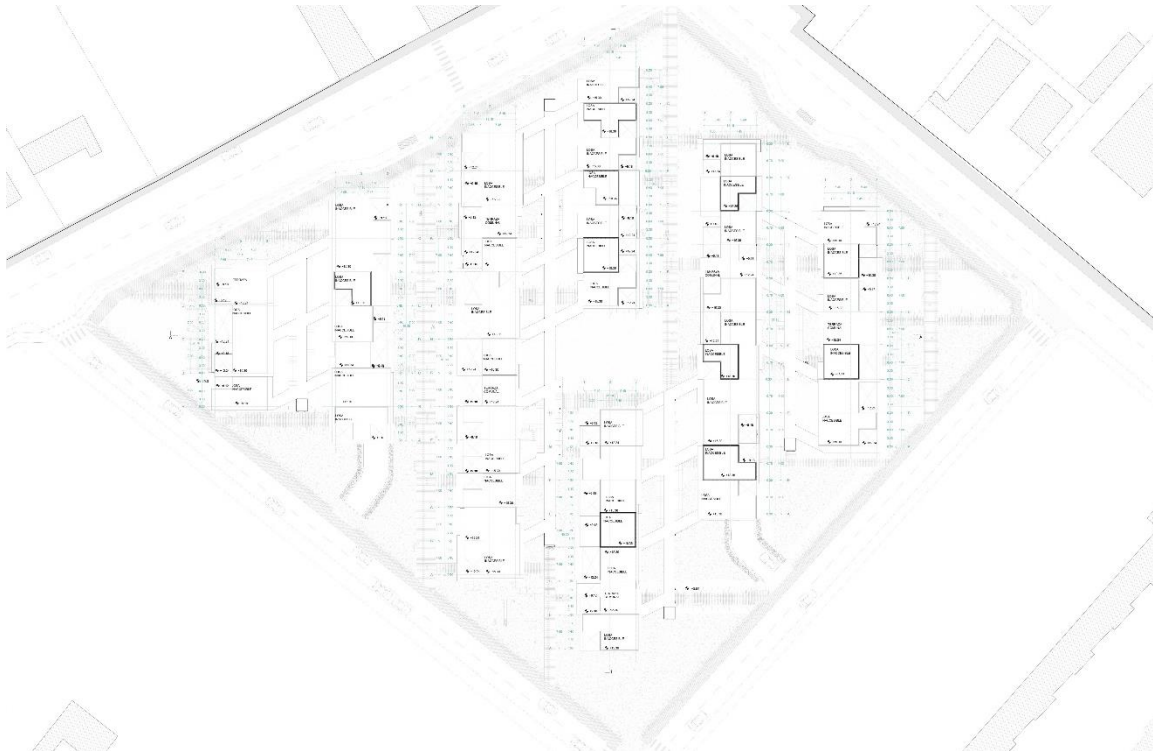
Planta nivel +9.18 (Cuito, 2017)
